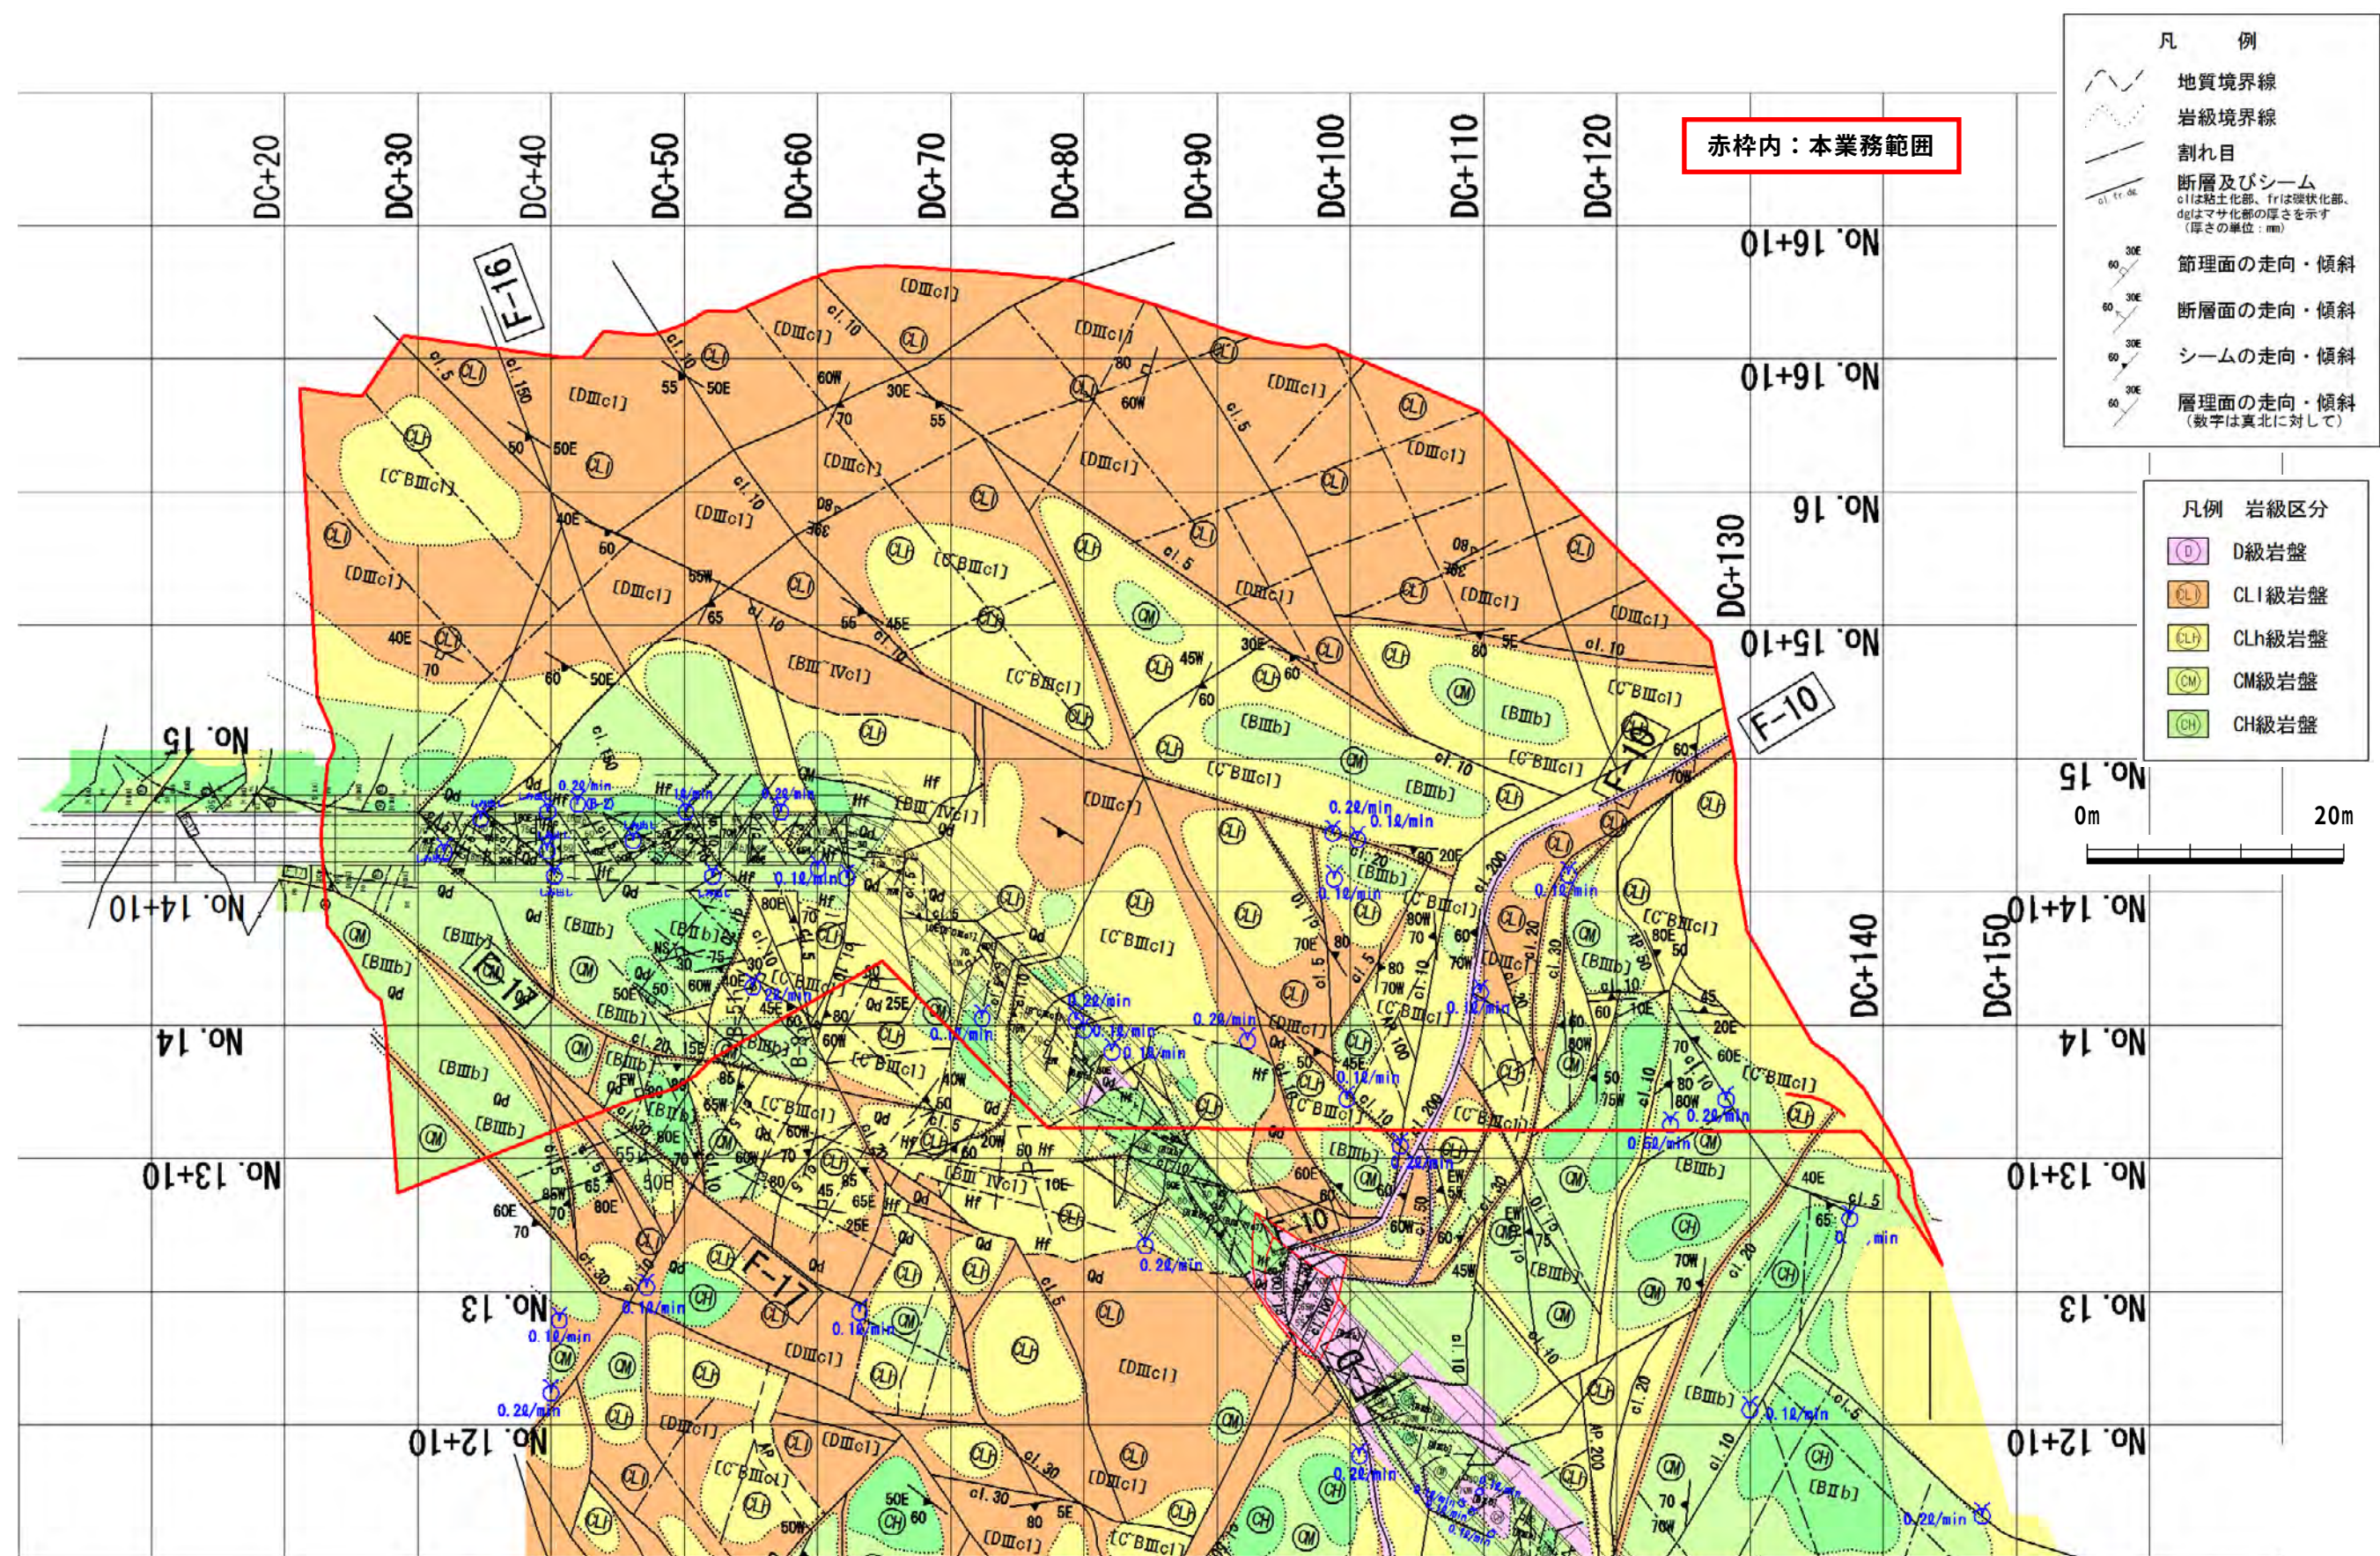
岩盤スケッチ平面図 (岩級区分) (下流側)
